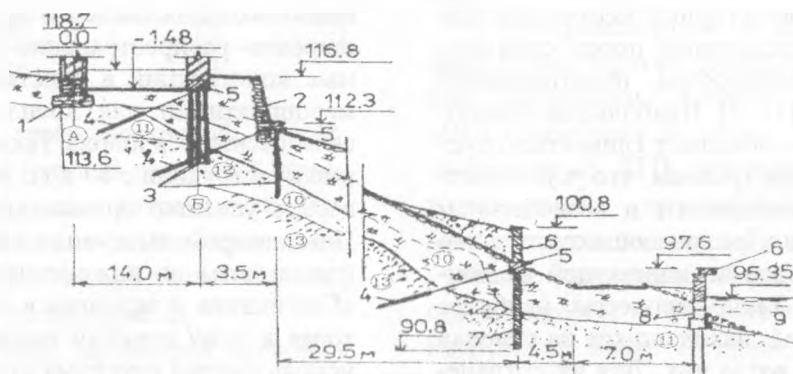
Схема противооползневых конструкций возле Каложской церкви: 1 – существующий фундамент; 2 – каменная подпорная стена, 3 – сваи; 4 – анкеры; 5 – ростверк; 6 – подпорная стена; 7 – набивные сваи; 8 – стеновые блоки; 9 – река; 10 – насыпной грунт; 11 – песок, 12 – гравий; 13 – суглинок
